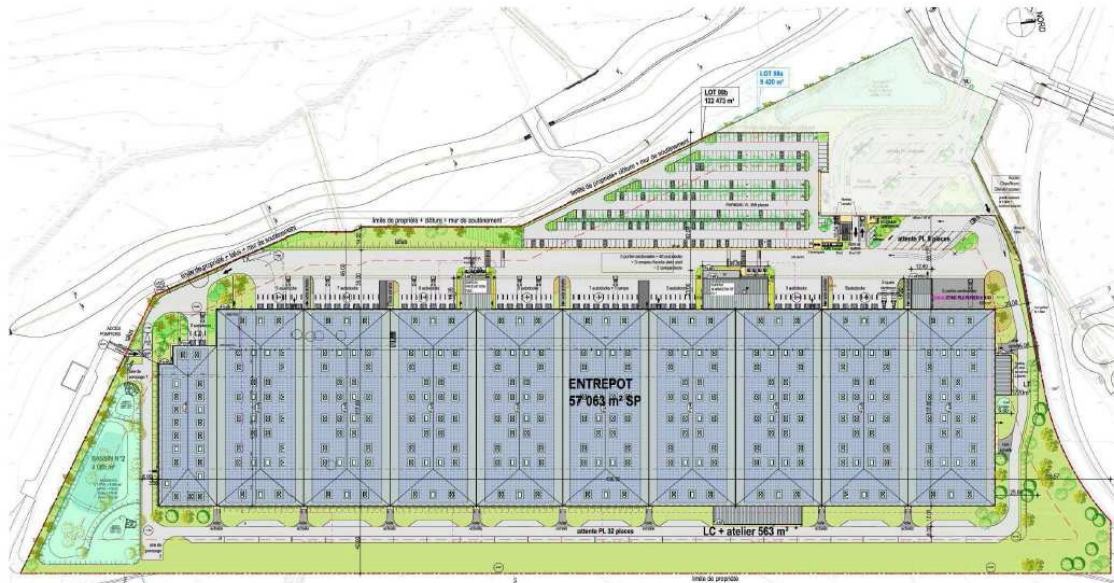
Plan de masse général du site lot 8 (source Barjane)
